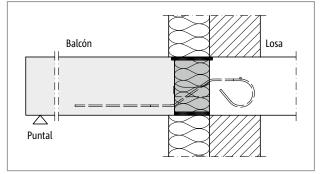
Schöck Isokorb® XT tipo Z, Q: Sistema de aislamiento térmico exterior (SATE)
